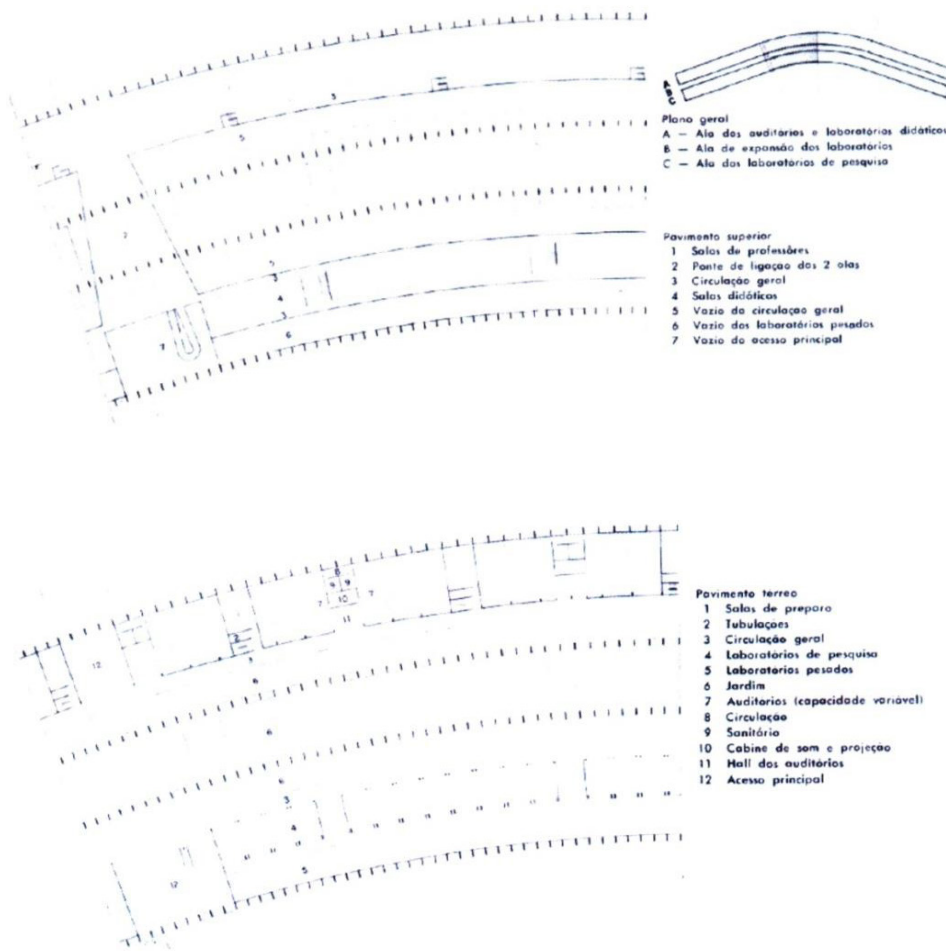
Planta Baixa pavimento superior ICC. Fonte: Acrópole, 1970.
